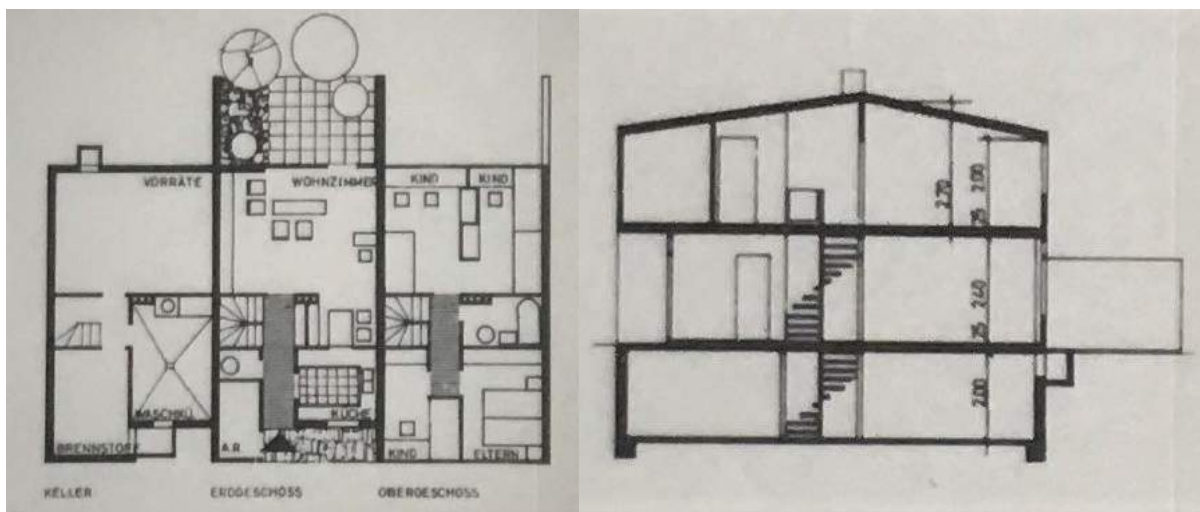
Grundriss und Schnitt der Reihenhäuser in der Siedlung Böhlerwerk, 1959
